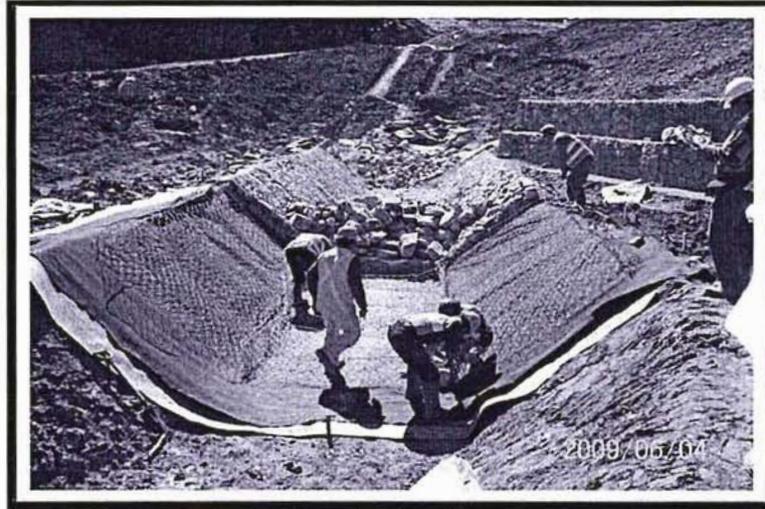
Construcción de canal de conducción y descarga proveniente de la captación (coronación) del Depósito de Relaves 1; las hojas de HDPE (geomembrana) están siendo pegadas con un dispositivo de calentamiento eléctrico.
